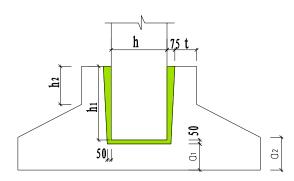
预制钢筋混凝土柱独立基础示意图 注: a<sub>2</sub>≥a<sub>1</sub>
